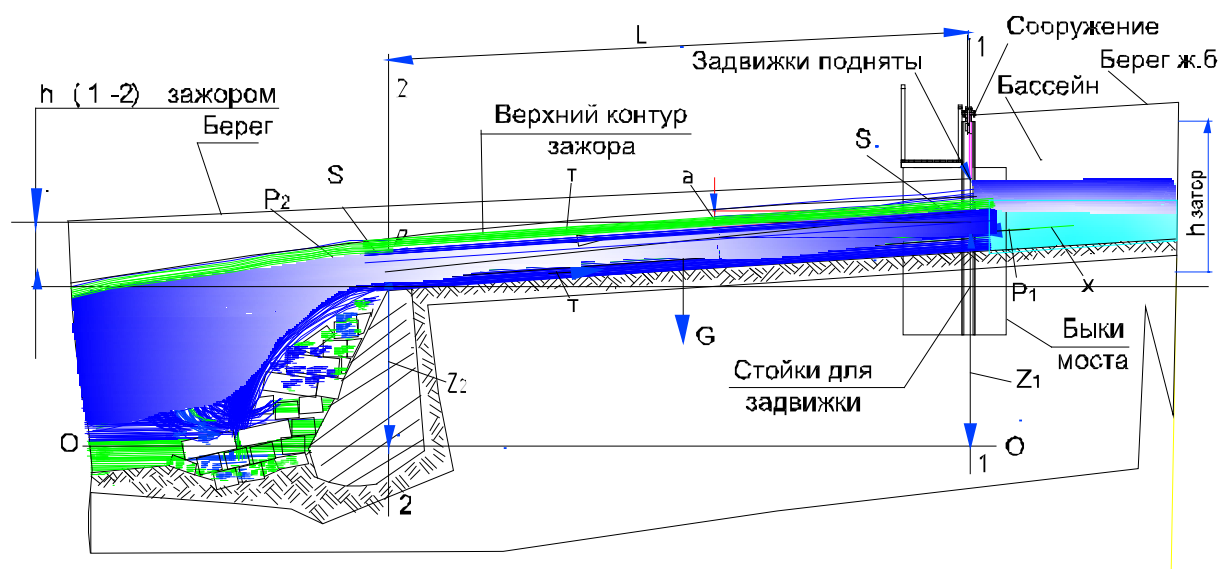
Схема участка в продольном сечении по руслу реки Ала-Арча сооружением, второе начальное условие, (температуре воздуха выше -8°C над рекой)
